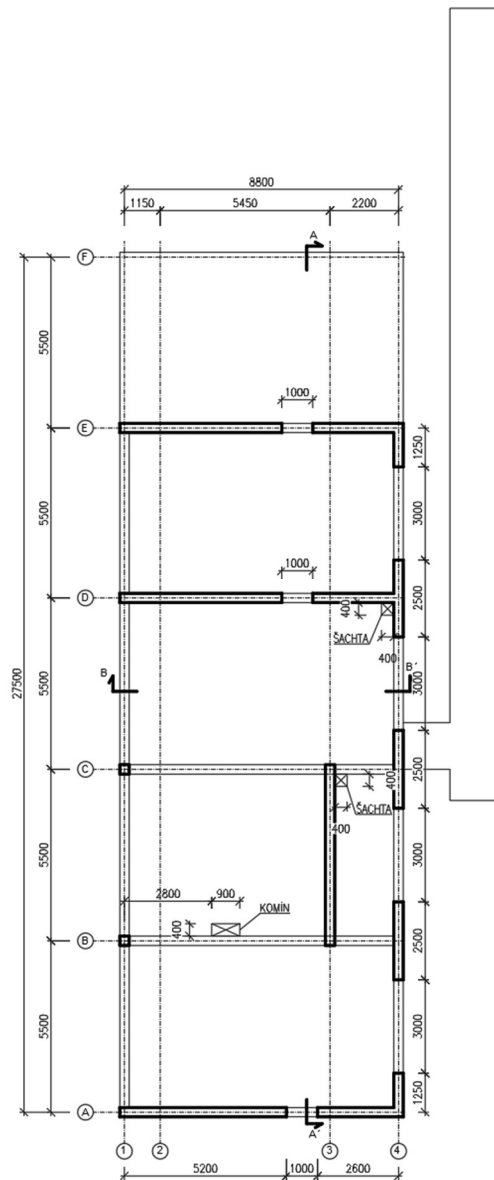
(půdorys, konstrukční schéma 1.PP)
